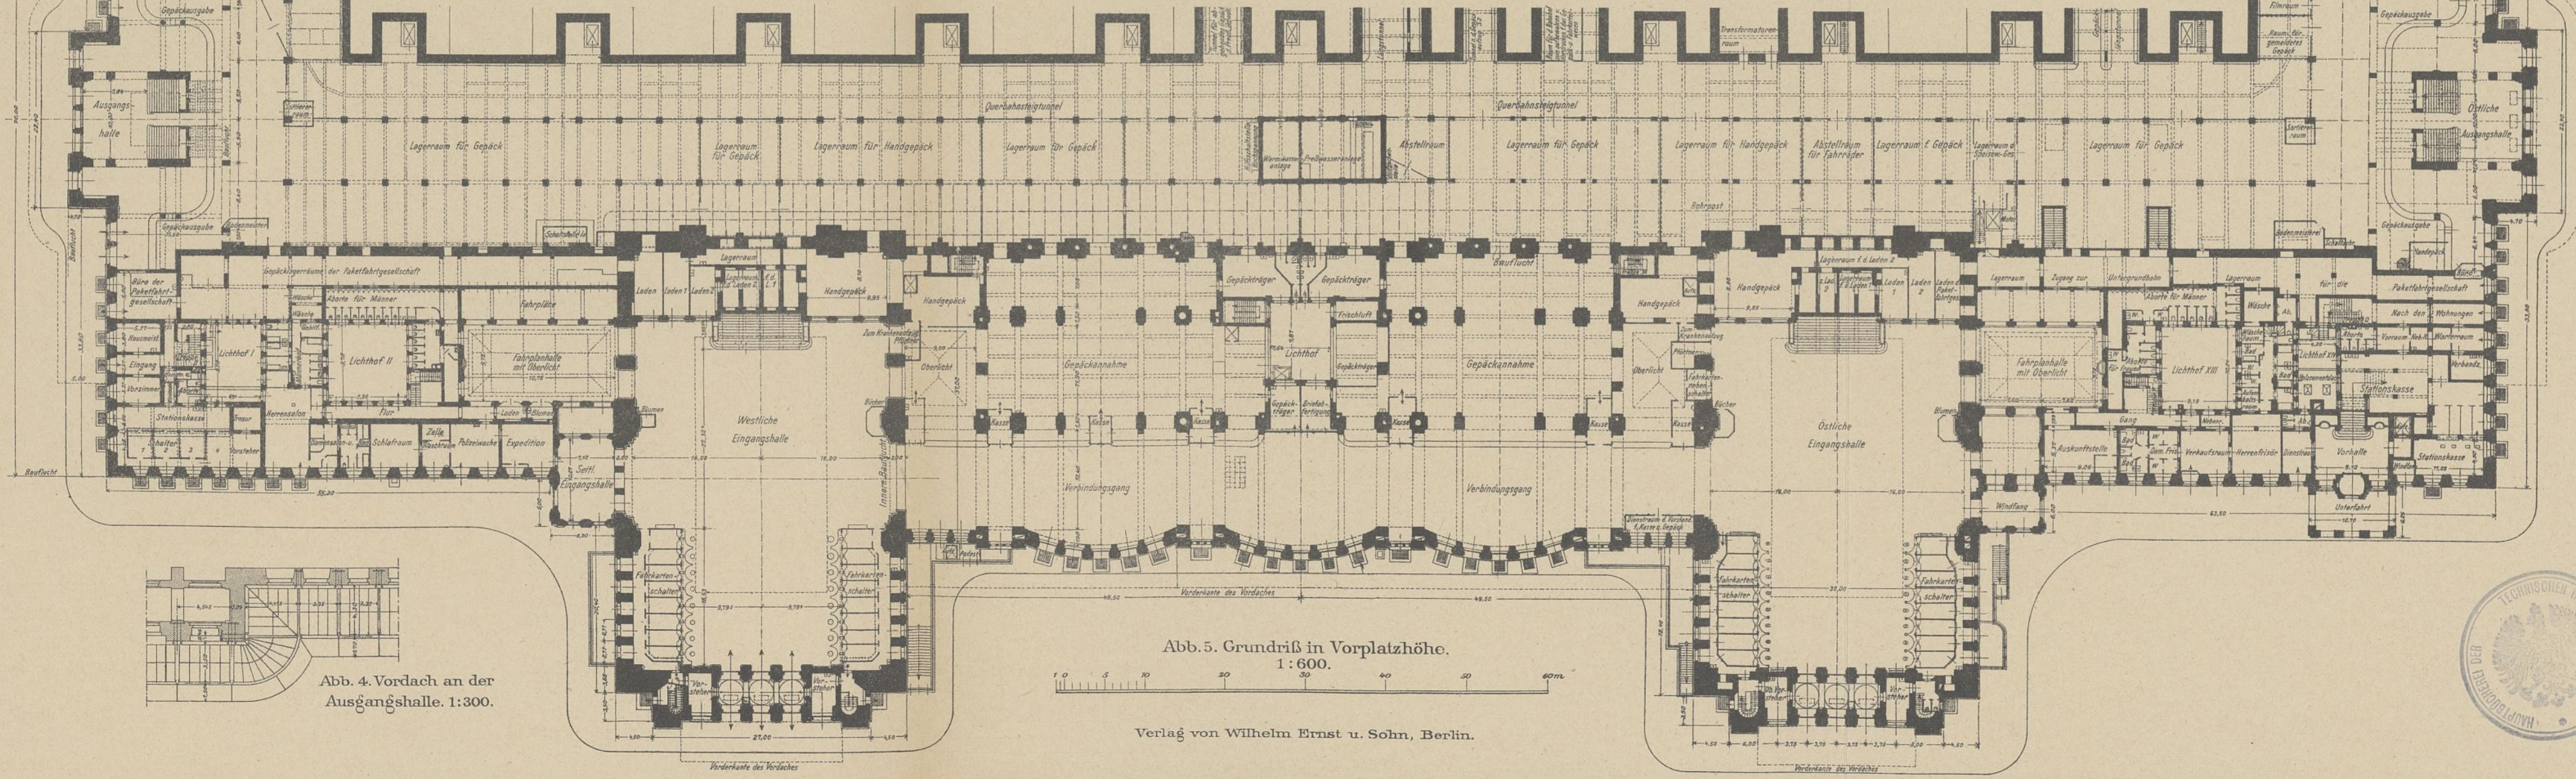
Grundriß in Vorplatzhöhe. 1:600.
